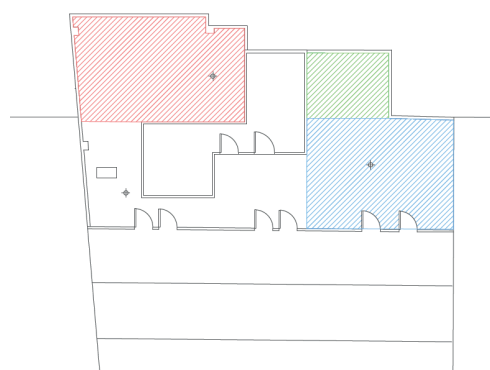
Espacios en los que se ha dividido la cubierta plana transitable. Arín, 2019.
